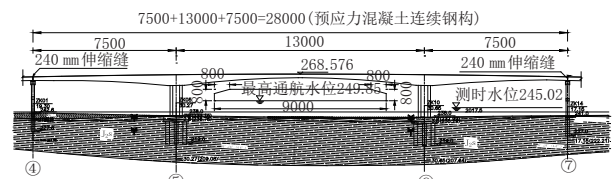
怀德沱江大桥主桥立面布置图(单位: cm)
